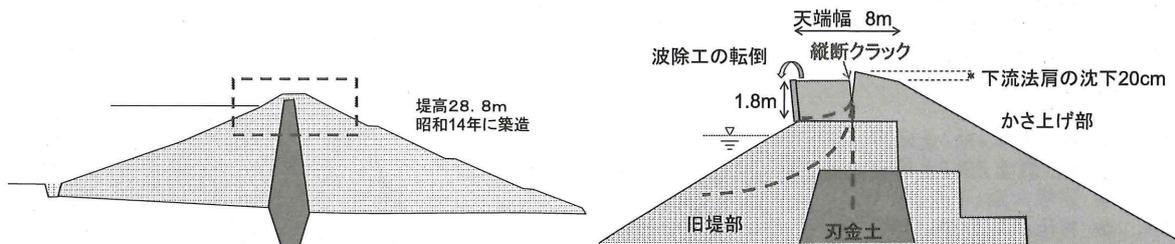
Mダムの被災状況 左：断面図、右：天端部断面
